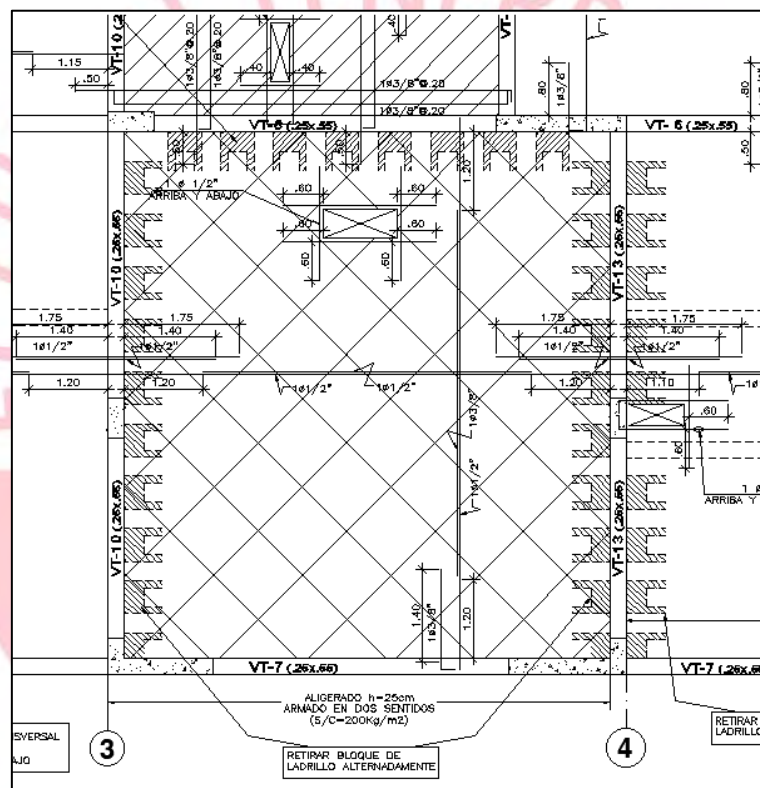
Distribución de refuerzo en losa aligerada en 2 direcciones.
